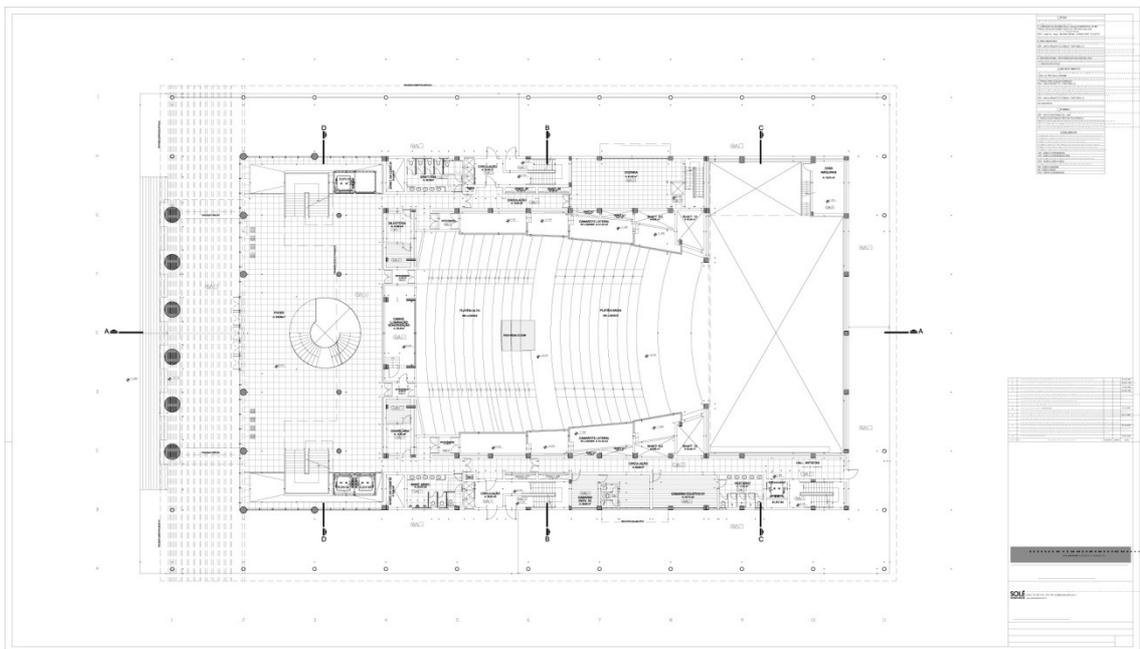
Planta do pavimento térreo do Paço Municipal em Paulínia.
